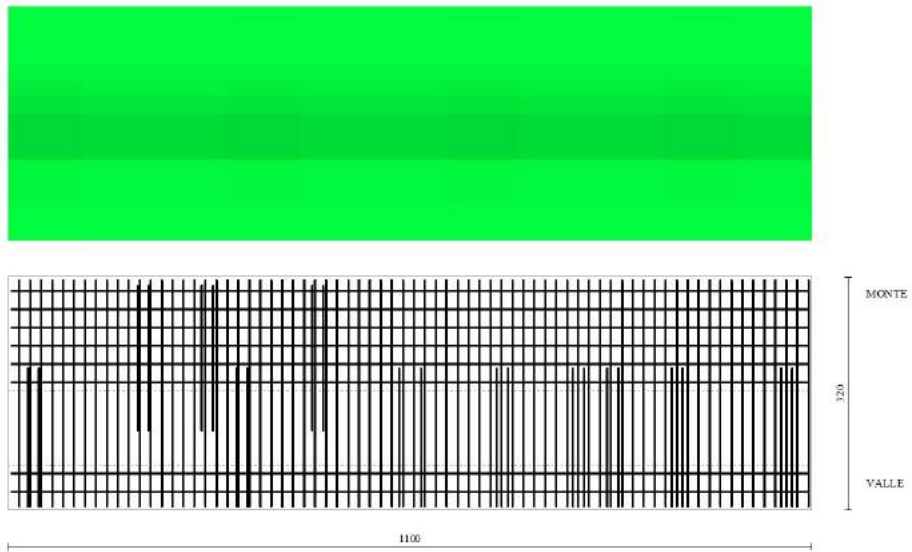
Piastra fondazione dir. Y (Inviluppo)
